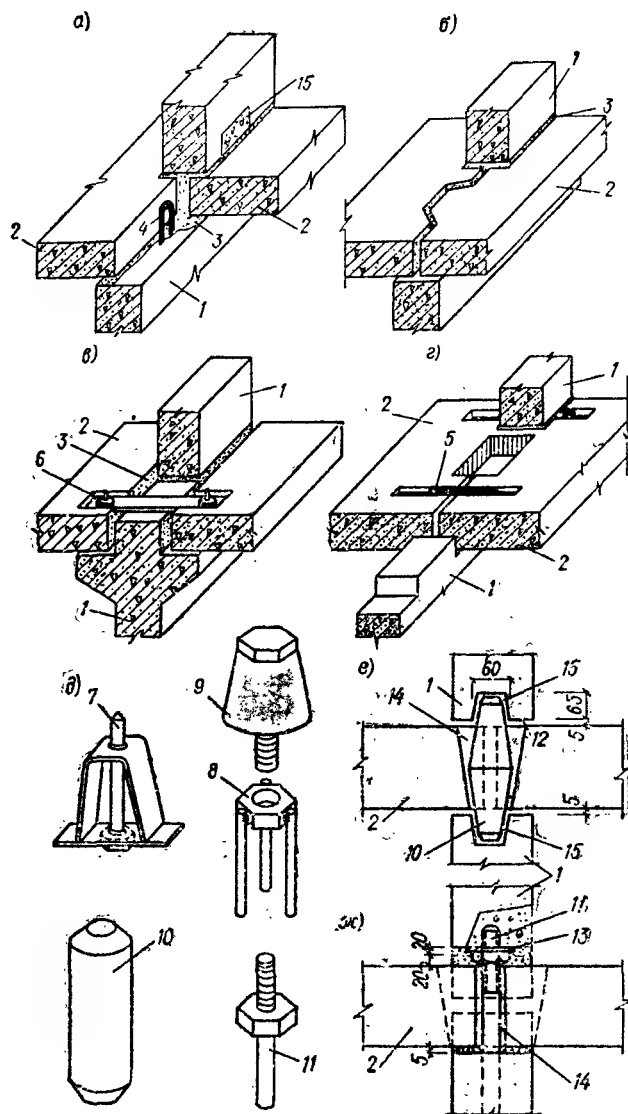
Стыки внутренних несущих стен и панелей перекрытия
